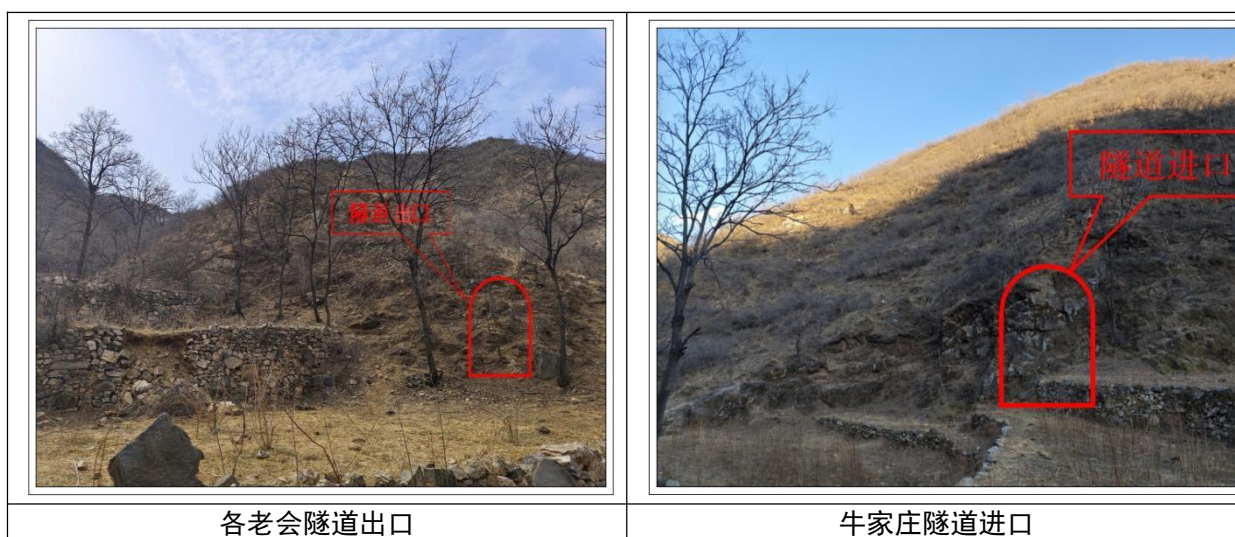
隧道进口施工场地位于生态保护红线范围内示意图
